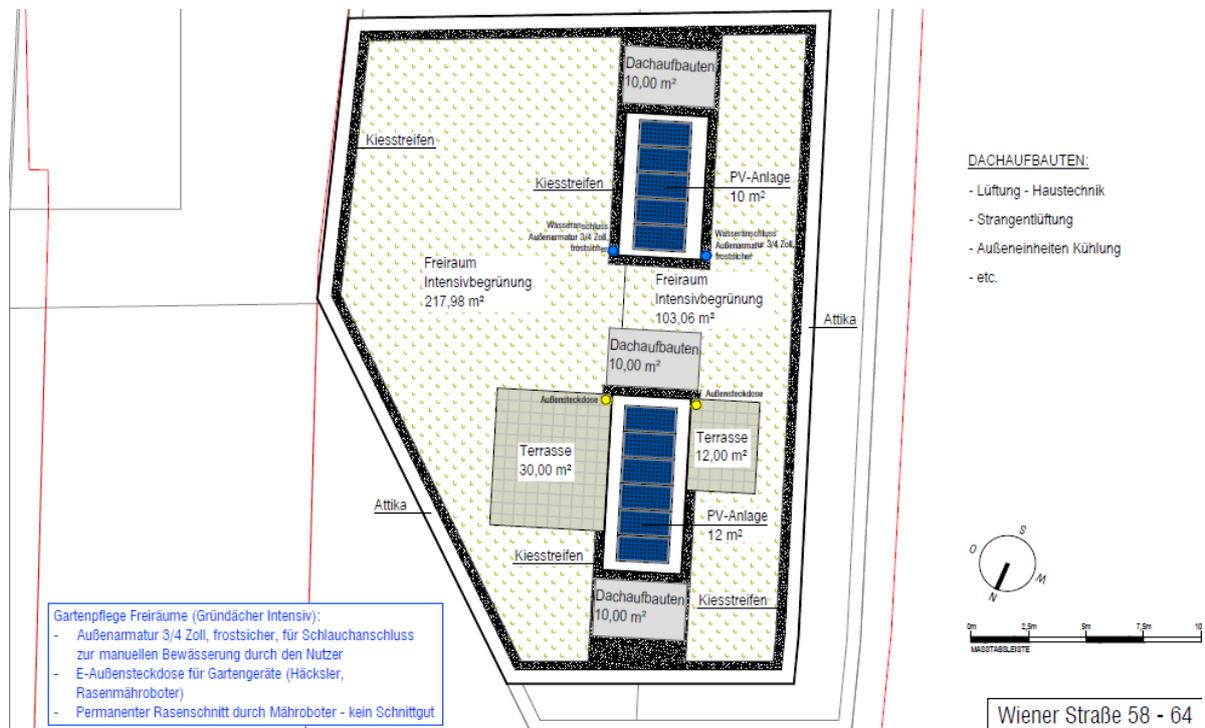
Beispiel geplante Dachgestaltung Parzelle Nr. 3290, KG Krems
